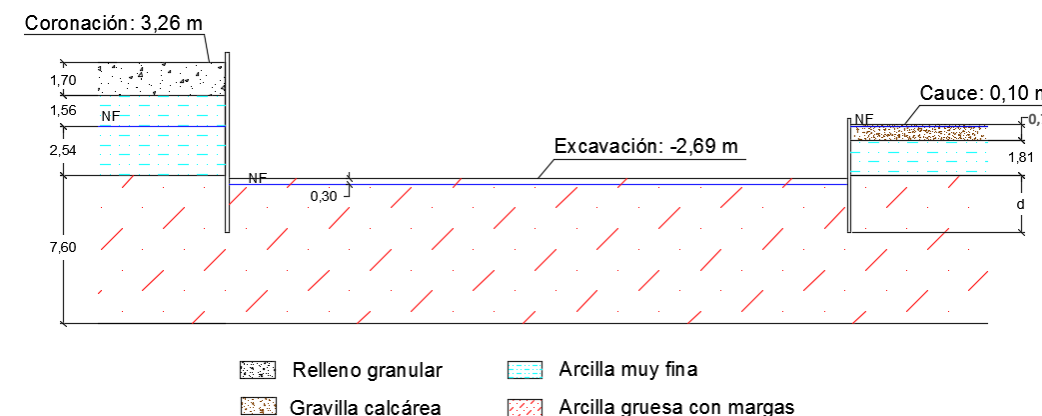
Estratos existentes en el estribo sur y posición de tablestacas. Elaboración propia con AutoCAD.
